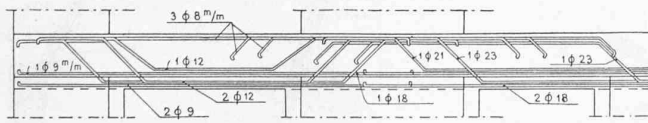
Vue des sommiers 808-809. — 1 : 60.
